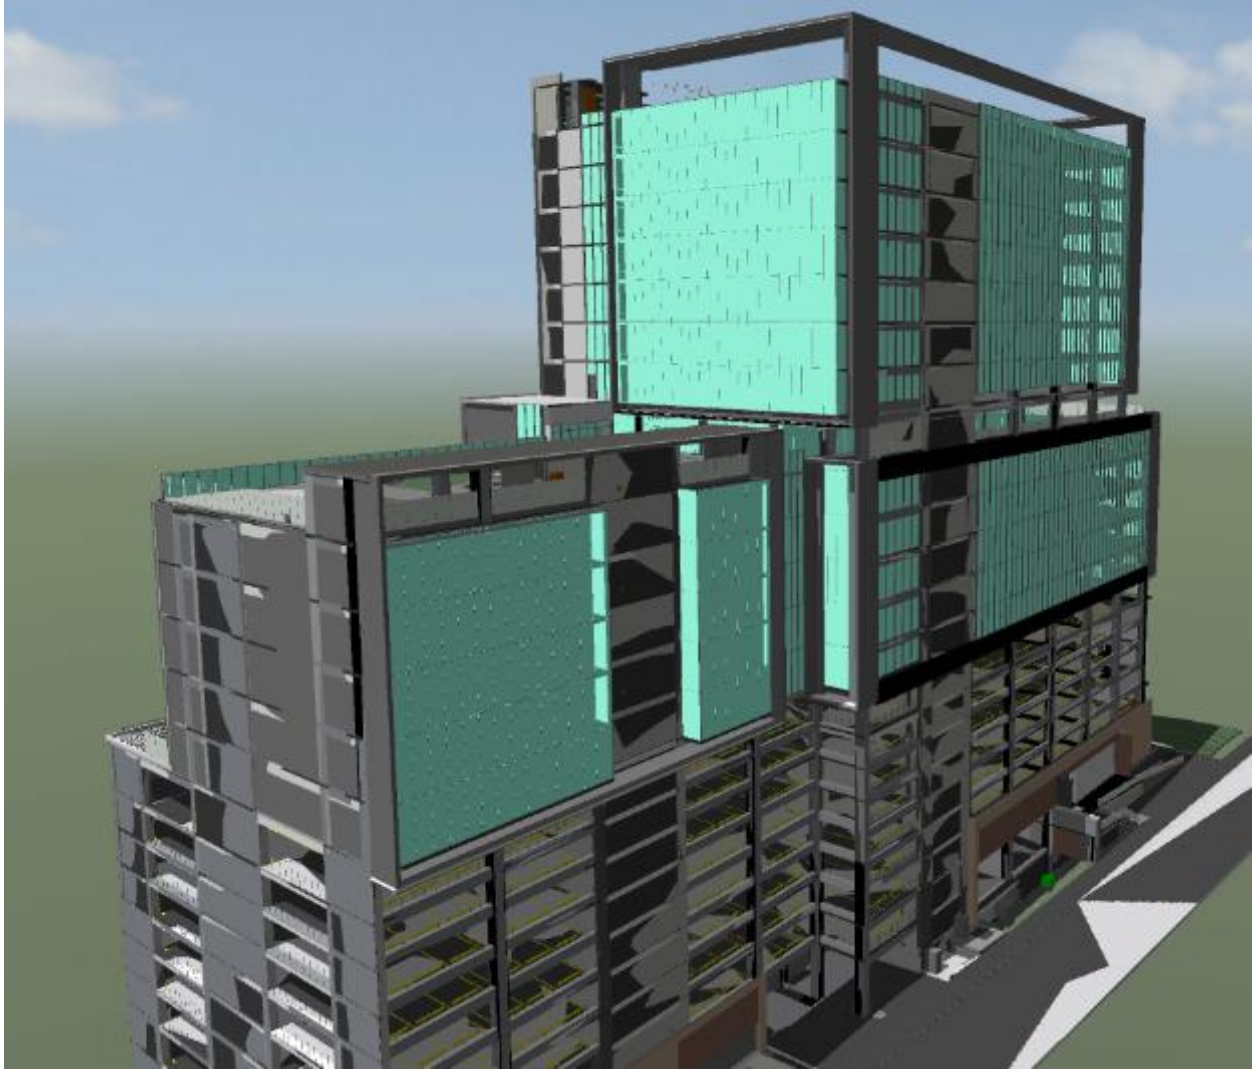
Fachada sureste. Fuente: Extralum (2019)
